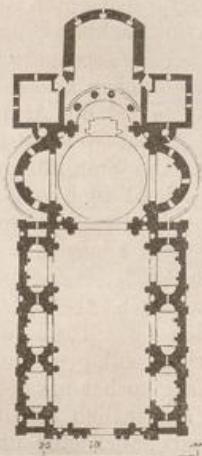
Kirche del Redentore zu Venedig. Grundriss.
